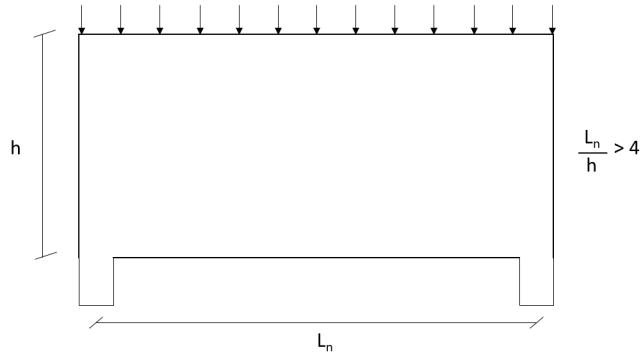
Geometría típica de una viga alta de hormigón armado
